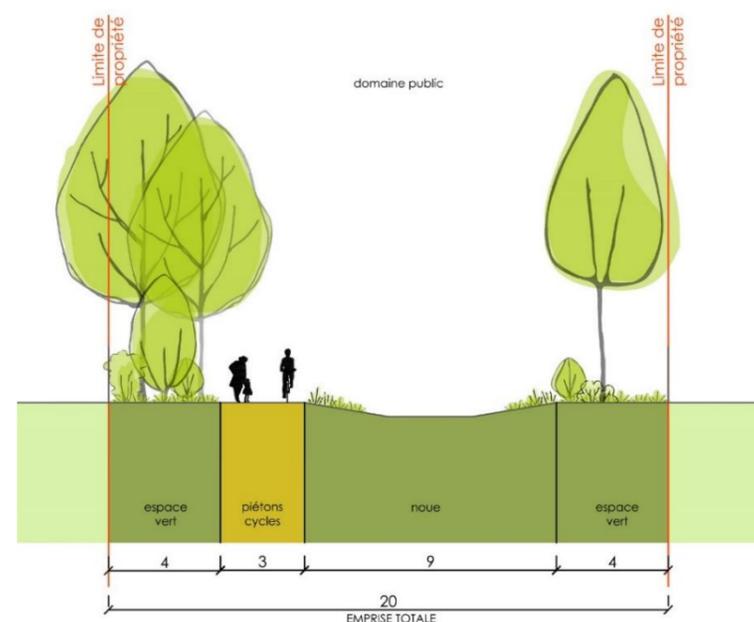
Coupe indicative des espaces de collecte des eaux pluviales
